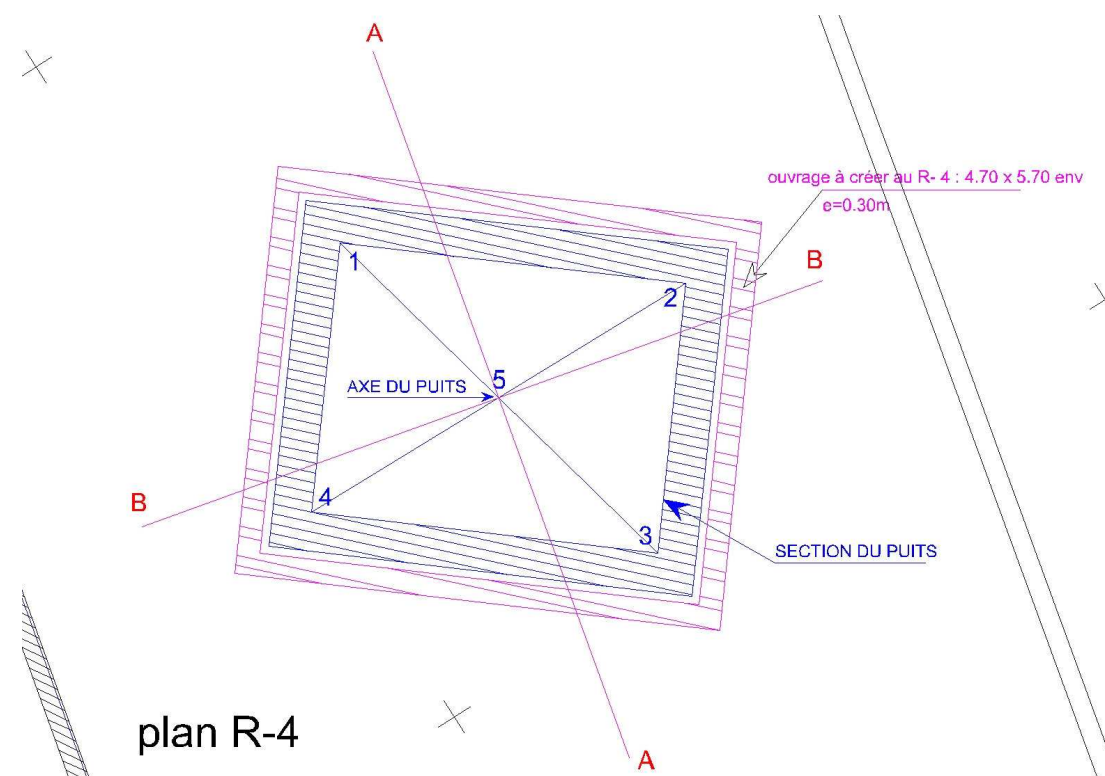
Vue en plan des ouvrages à réaliser au niveau R-4
